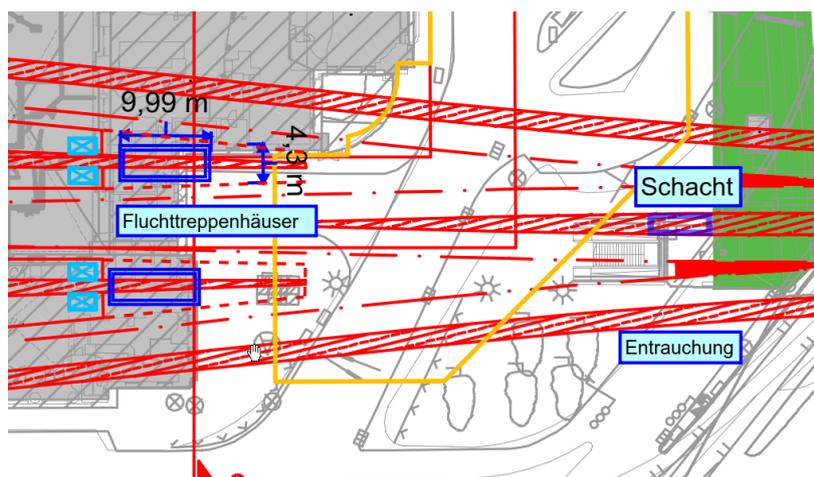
Lageplan Stationsvariante in offener Bauweise, Entrauchung, Nottreppenhäuser, Prinzipdetail Osteite Gleisebene
